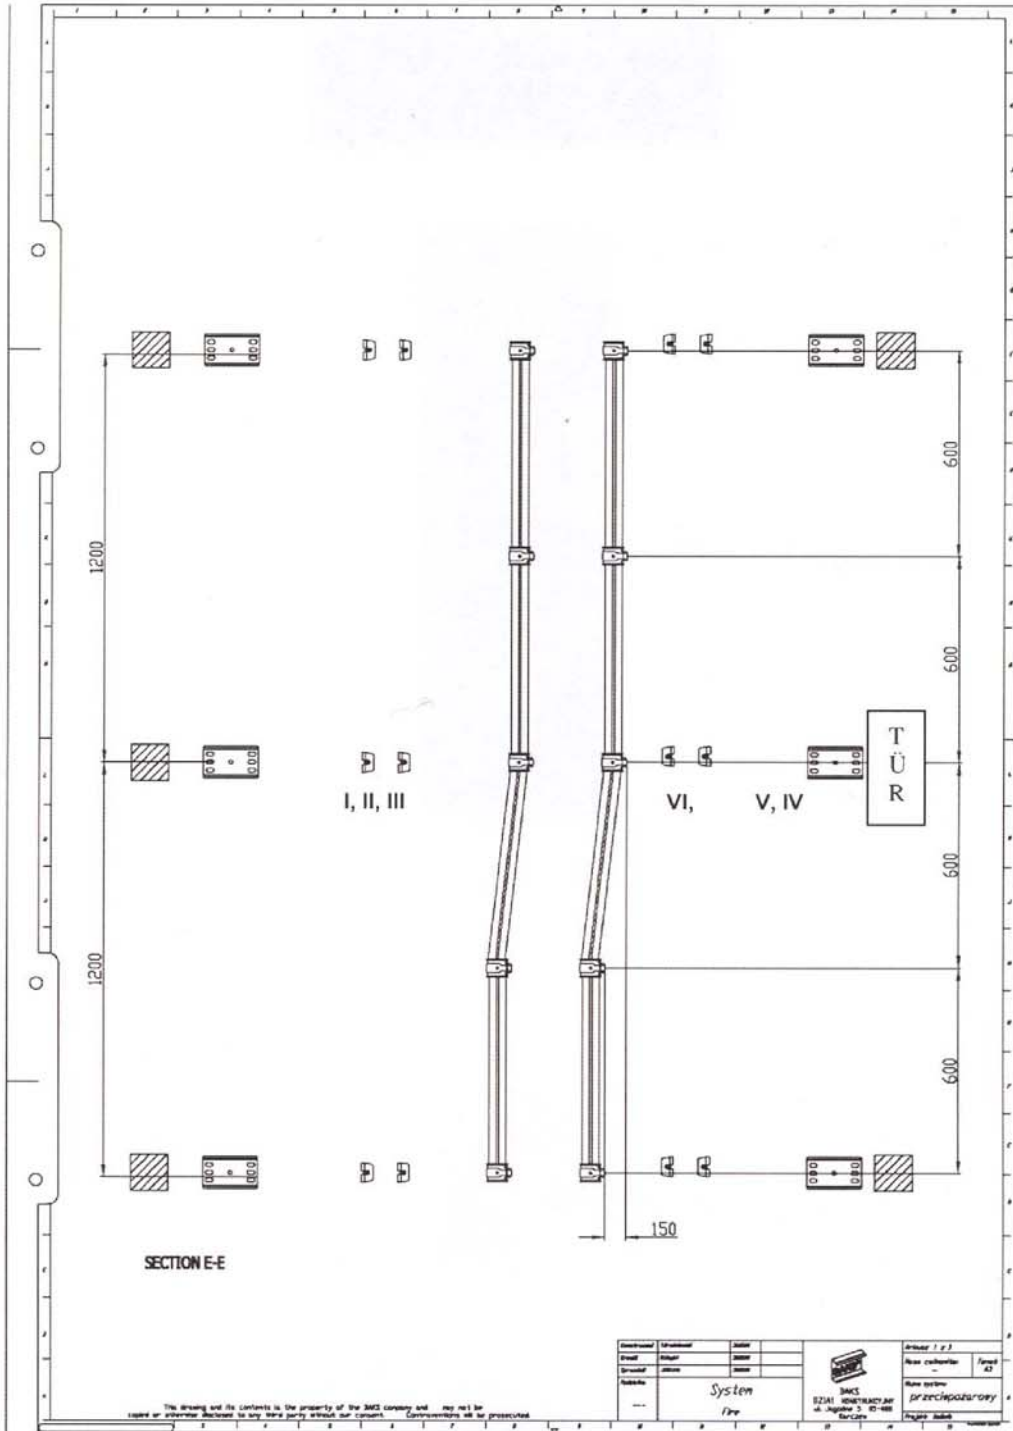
Lage der Thermoelemente im Grundriss
